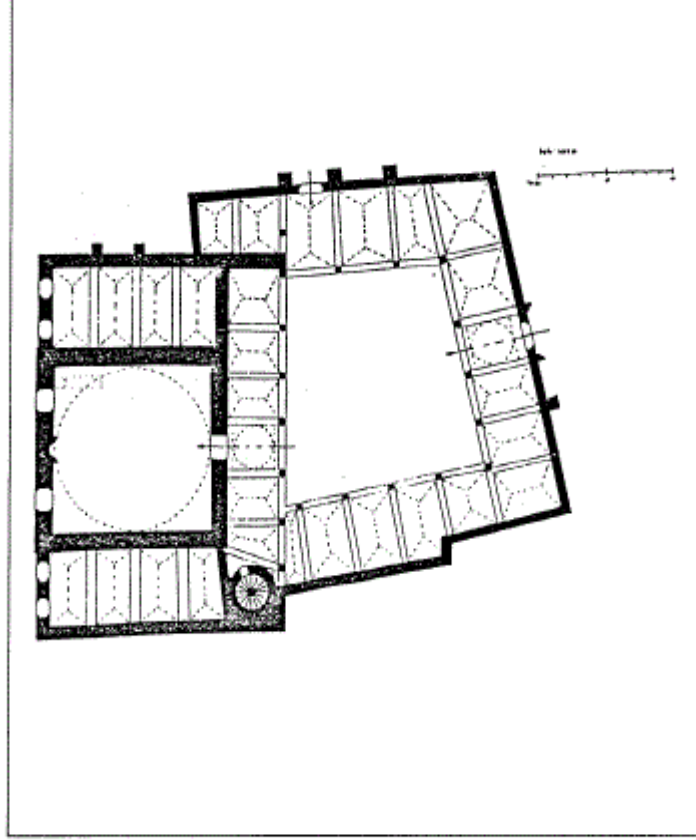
مسقط أفقي لمسجد الحنكار في سرايفو (عن : جودوين) .
